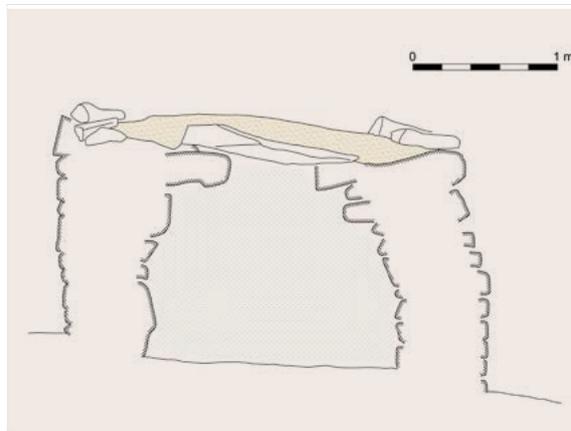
Corte de estructura rectangular en falsa bóveda del Sector E
